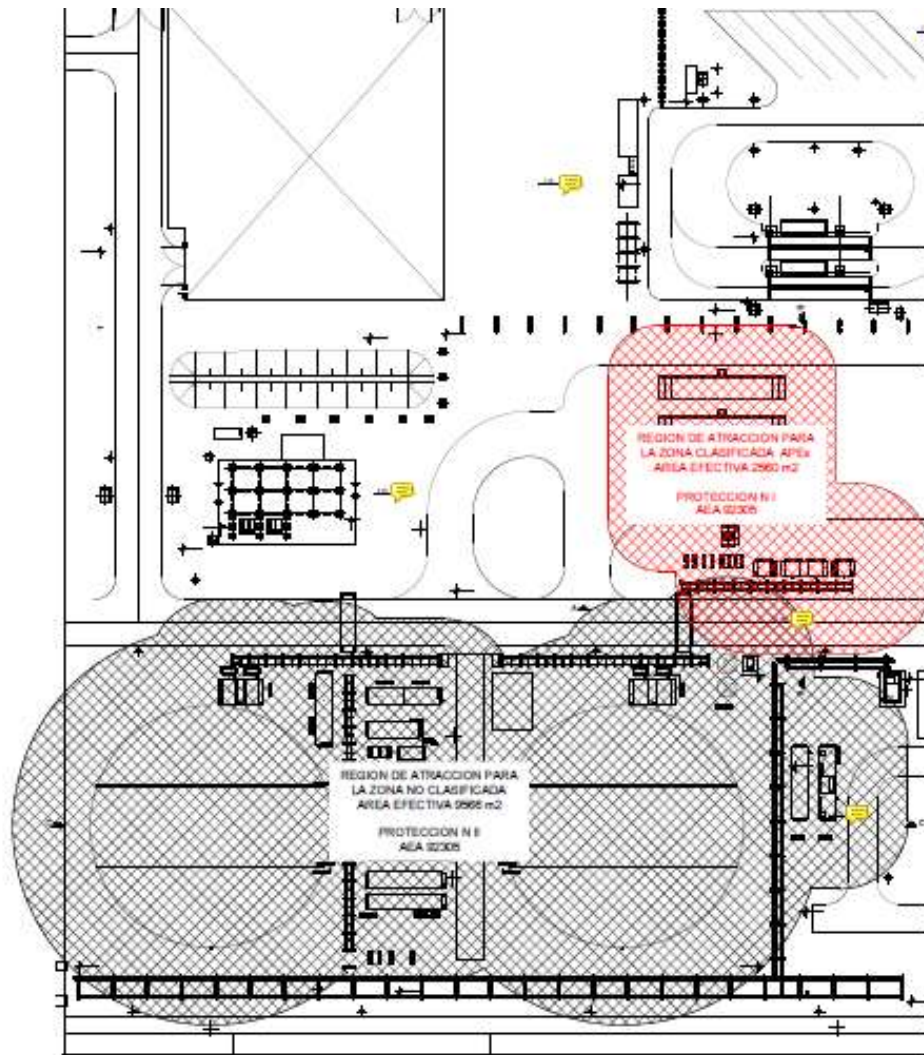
Vista en planta del alcance de la manta del sistema de protección atmosférica. Adjunto N°10
